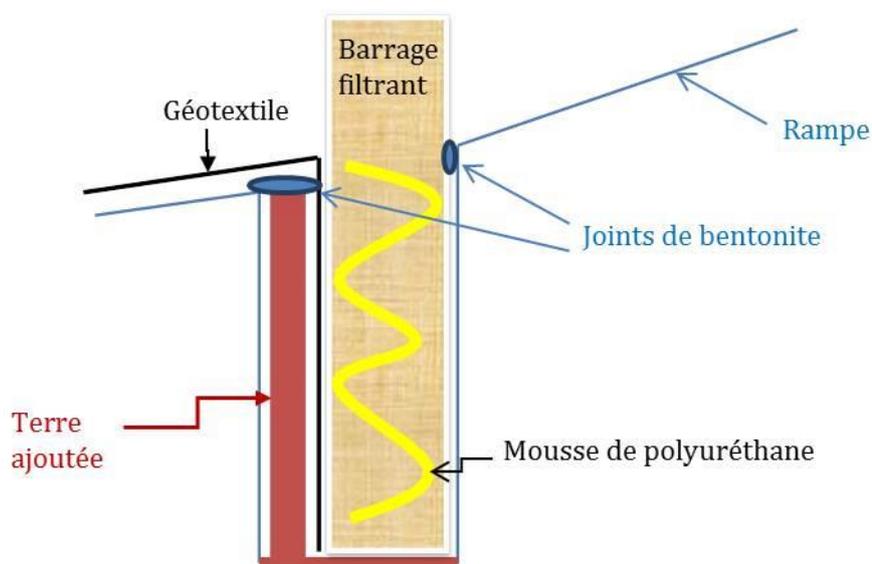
COUPE TRANSVERSALE SCHÉMATIQUE DE L'ENCHÂSSEMENT DU BARRAGE FILTRANT
